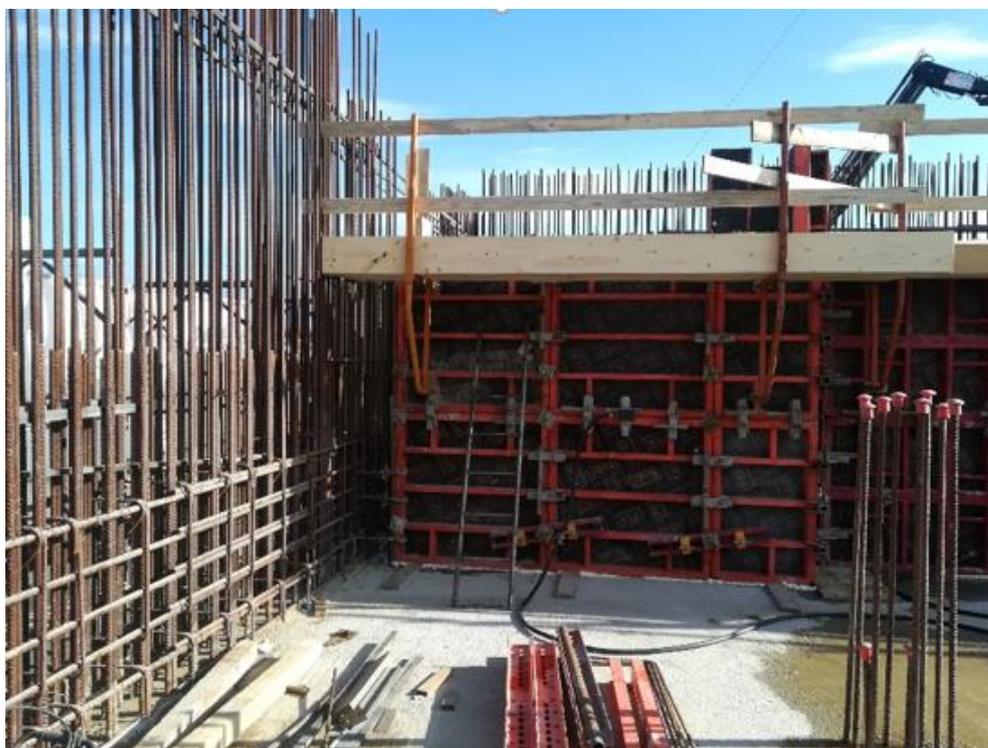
"Foto di cantiere durante il getto delle strutture in elevazione"
